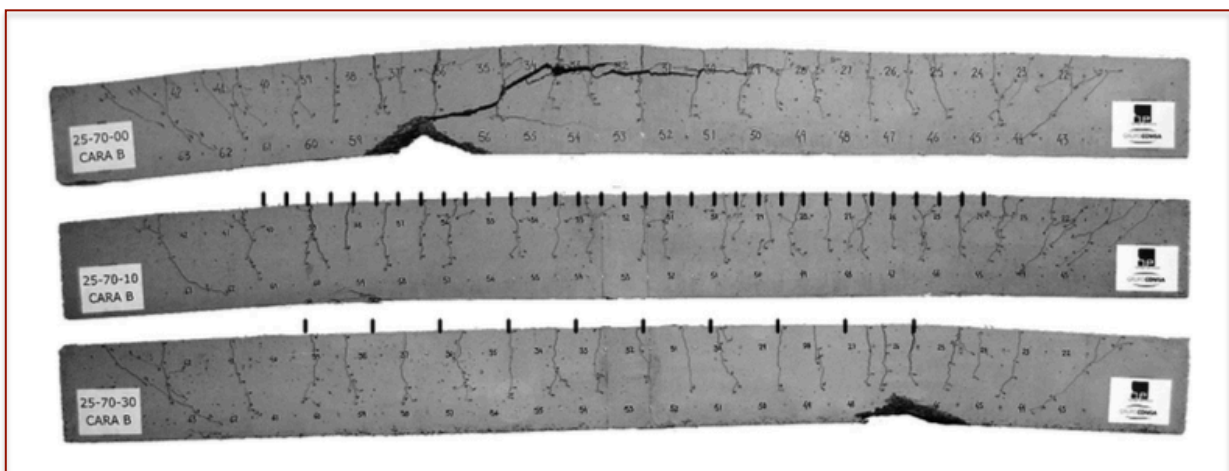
Efeito do espaçamento entre estribos no espaçamento de fendas, em vigas de diâmetros de 25 cm de armadura longitudinal ($c=70$ mm) [7].
